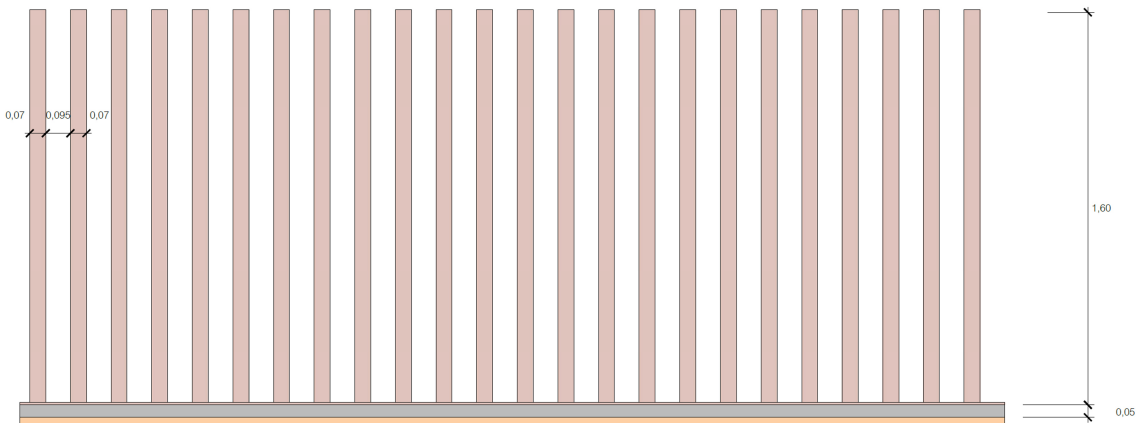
Alzado del vallado propuesto mediante perfiles tubulares.
